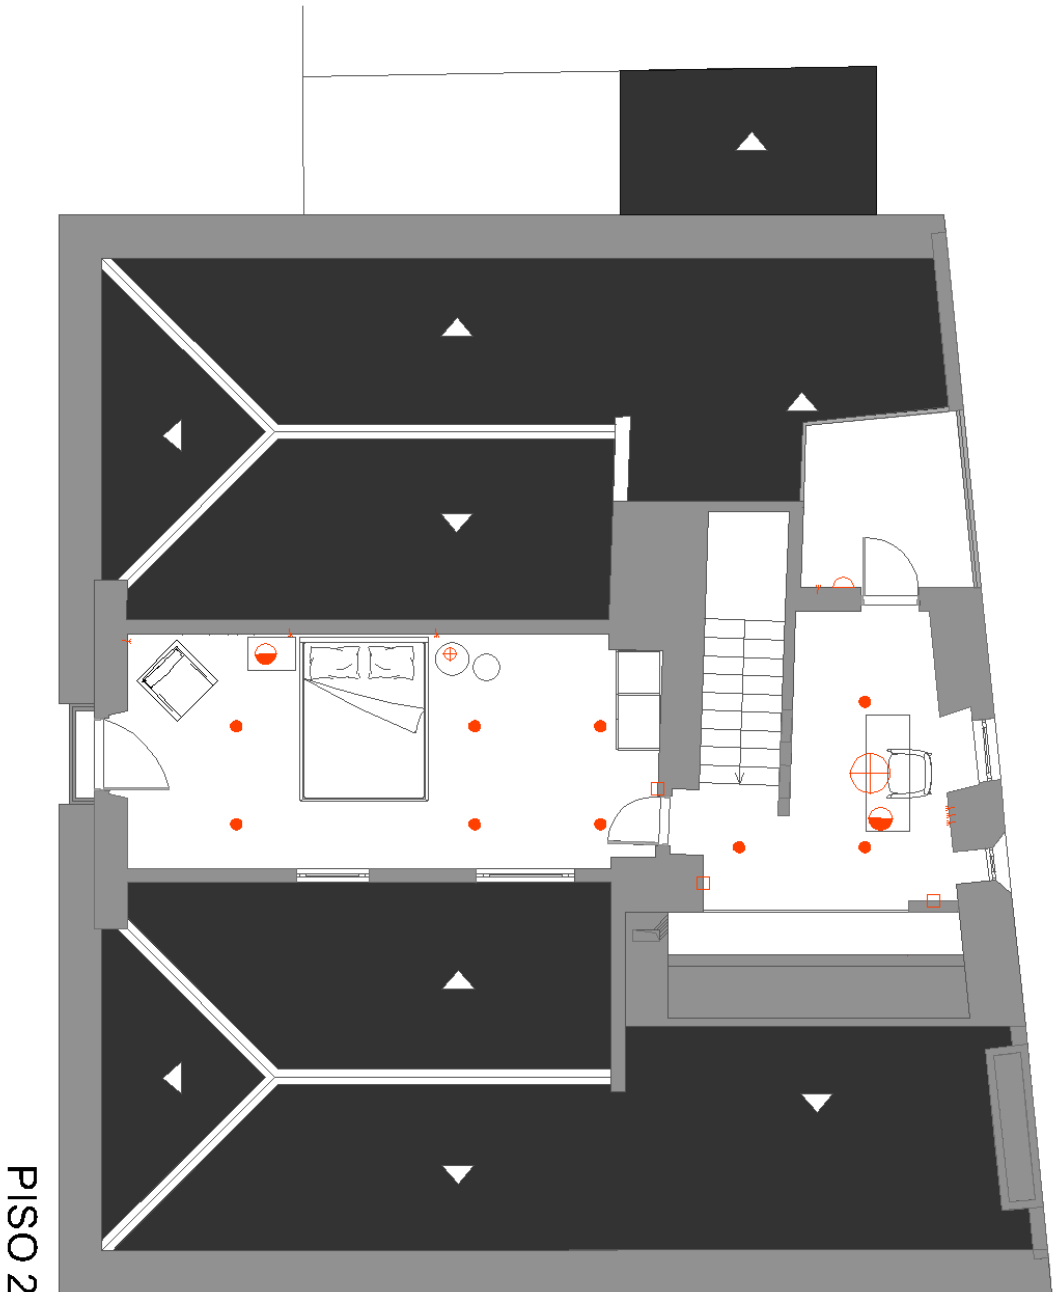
Layout de iluminação do piso 2 (Não está à escala)
